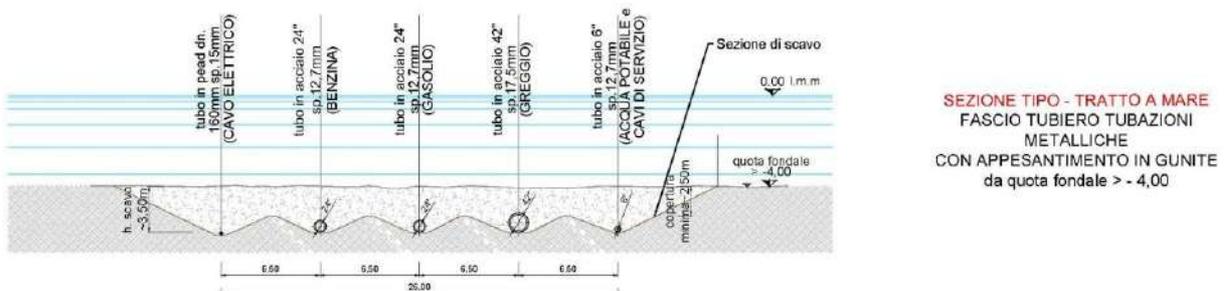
Fascio tubiero - tratto a mare: sezione di posa da quota fondale > - 4.00 m slmm.
